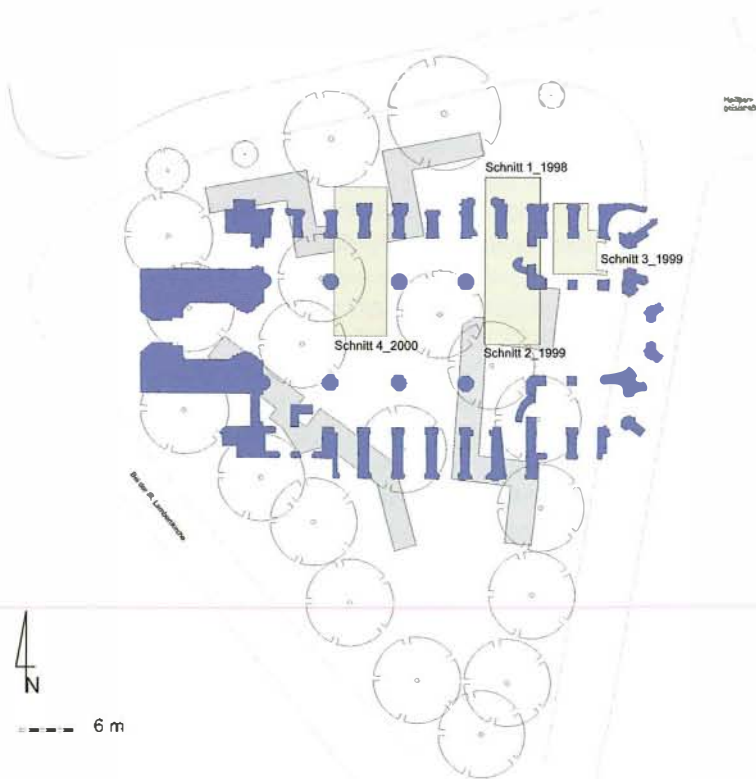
Grundriss der 1860/61 abgebrochenen gotischen St. Lambertikirche.
